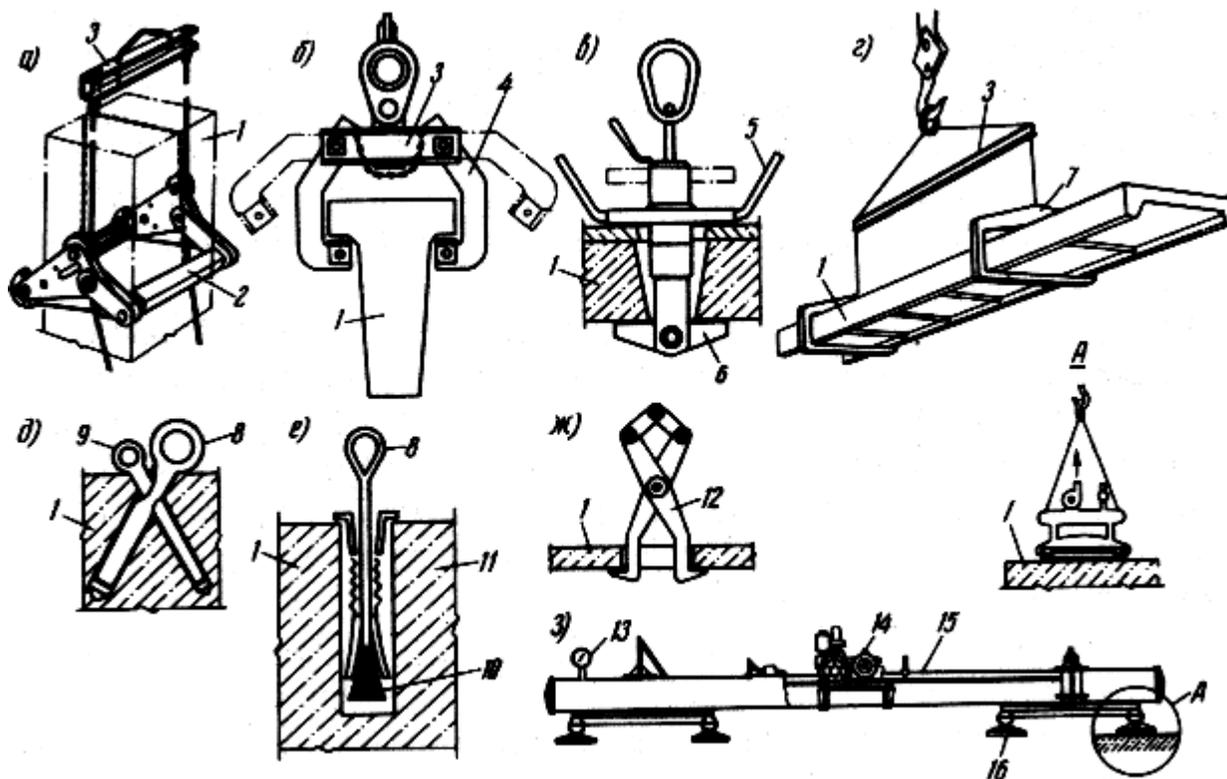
Конструкции захватов для беспетельного монтажа элементов:
